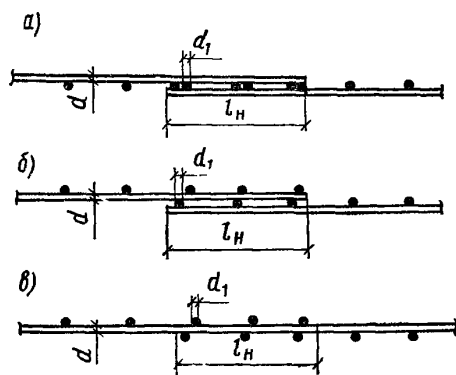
Стыки сварных сеток внахлестку (без сварки) в направлении рабочей арматуры при выполнении последней из стержней гладкой арматуры
